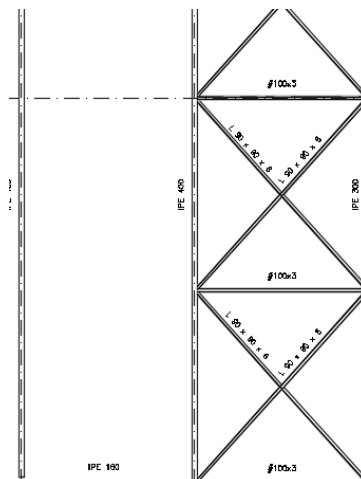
Viga Pratt faldón B. (Fuente: Cype 3D)
